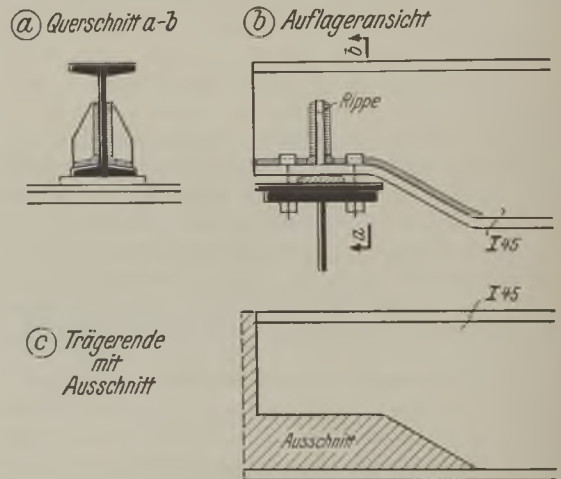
Trägerauflager mit Querschnittsverjüngung.
